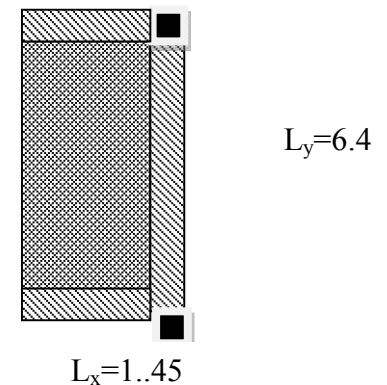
schéma de la dalle pleine sur trois appuis D_2 .
